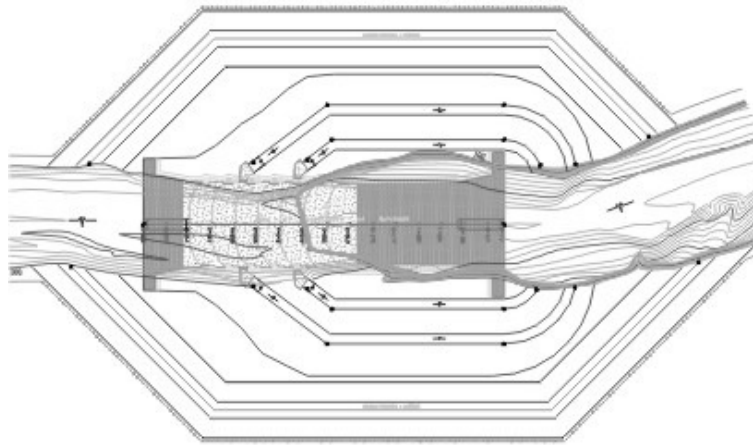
Planimetría general de la obra (flujo desde la izquierda).
